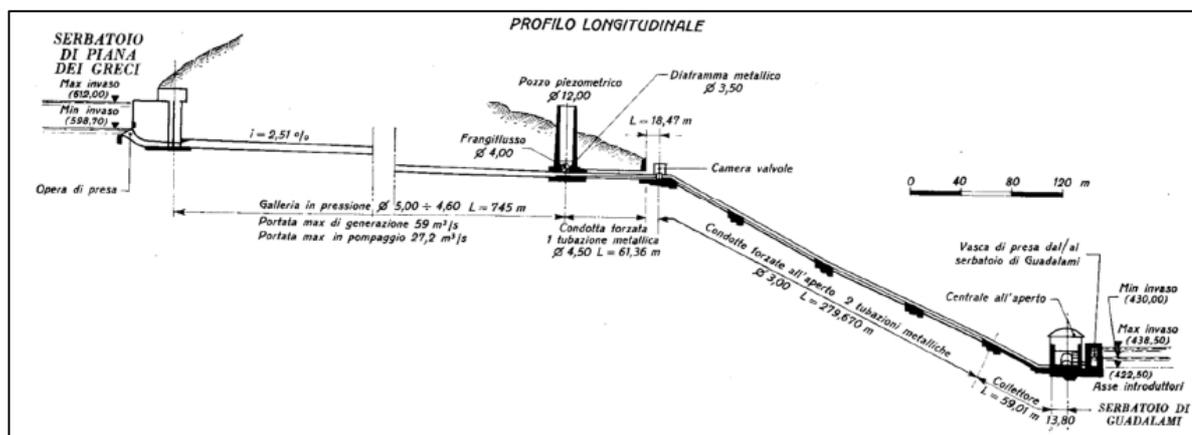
Profilo longitudinale della centrale di Guadalami
